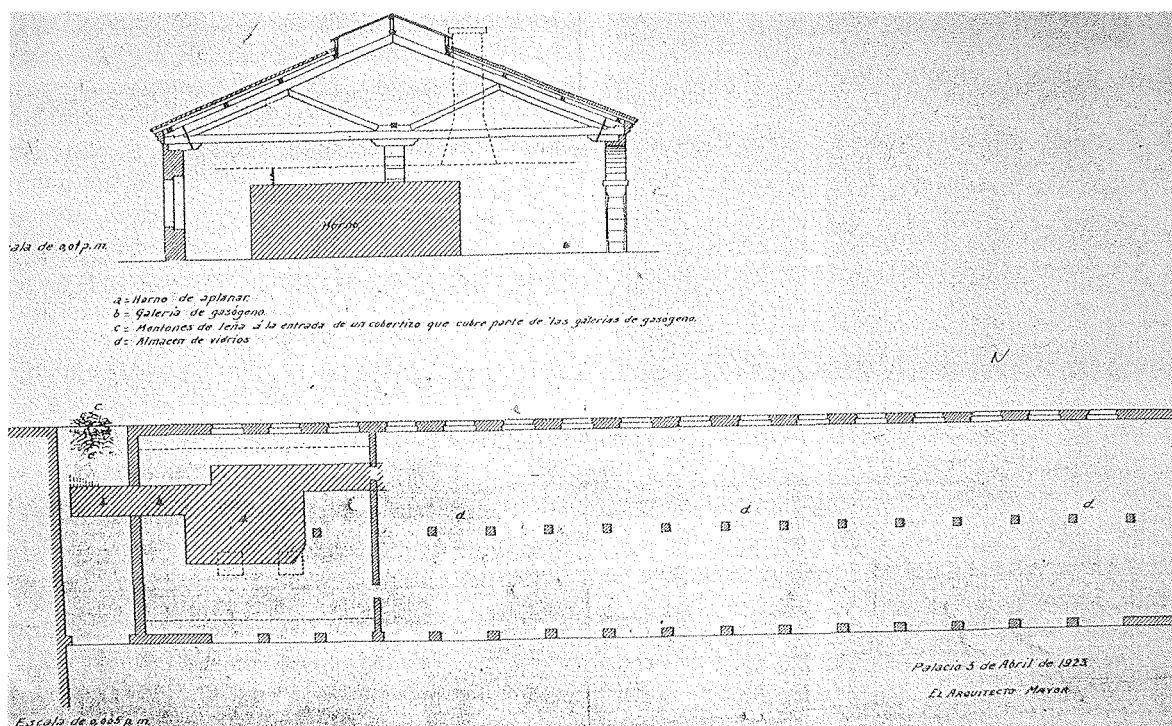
Cobertizo de leña donde se instaló un horno de aplanación, una galería de gasógenos y los talleres de corte, almacén y embalaje. 1923. Archivo General de Palacio. Sección planos nº 4.808.
